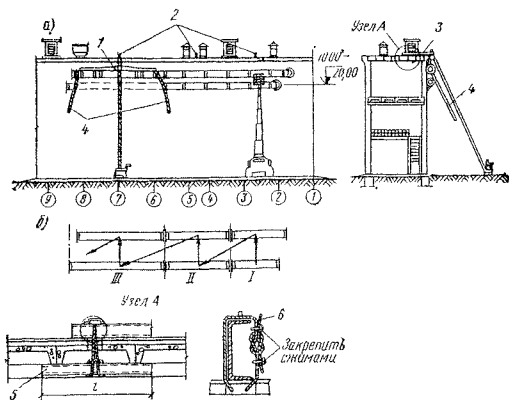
Схема монтажа горизонтальных воздуховодов по наружным стенам здания
